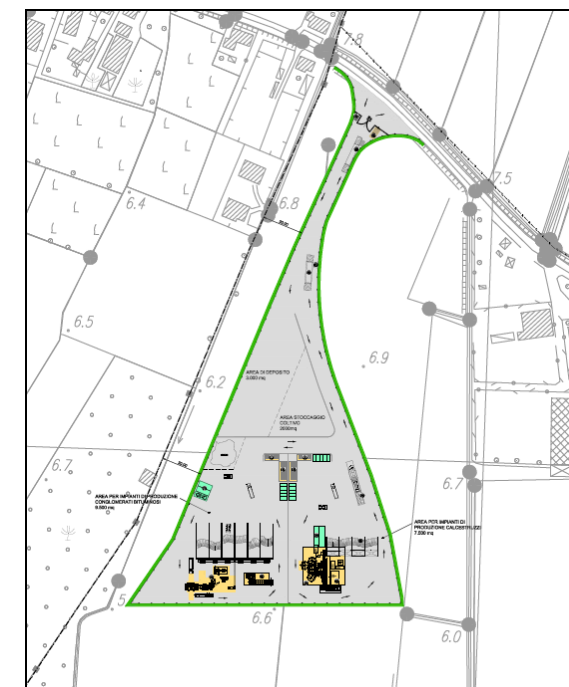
Planimetria e ortofoto area di cantiere CO01
